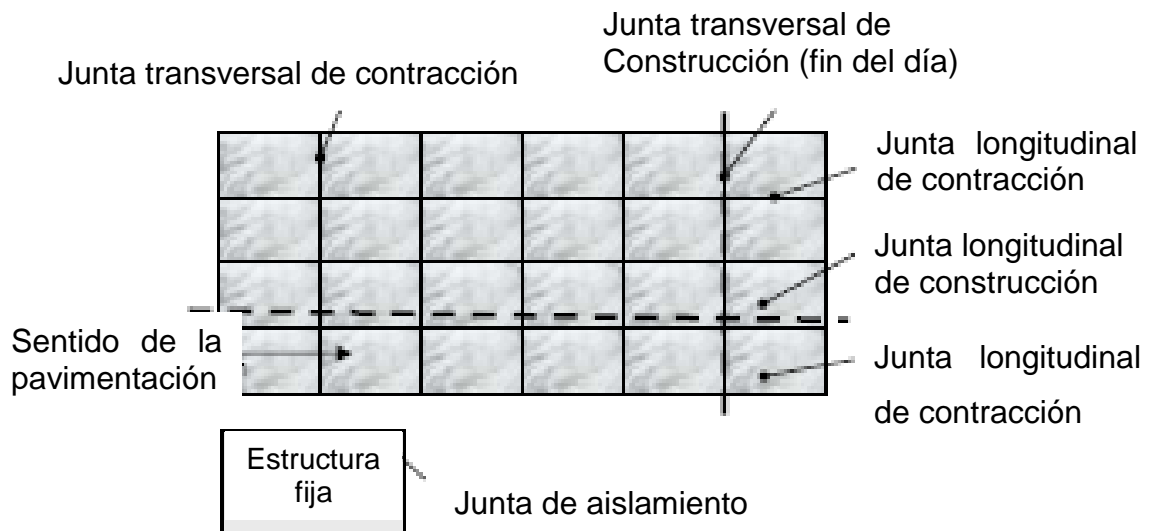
Tipos de juntas en pavimentos de concreto.
